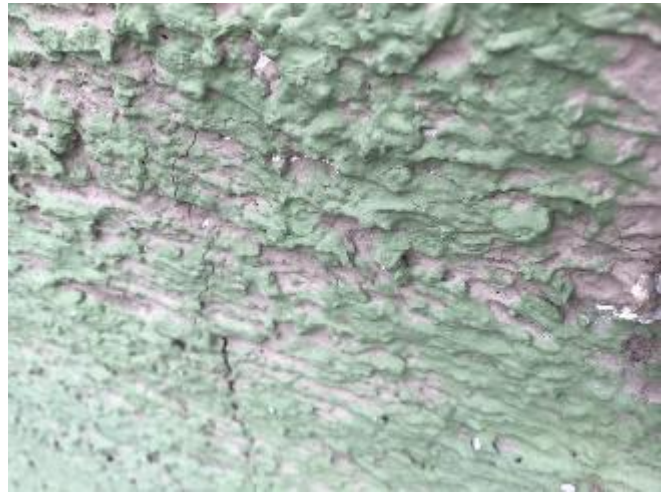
H2 | Fassade Bereich Schlafzimmer
